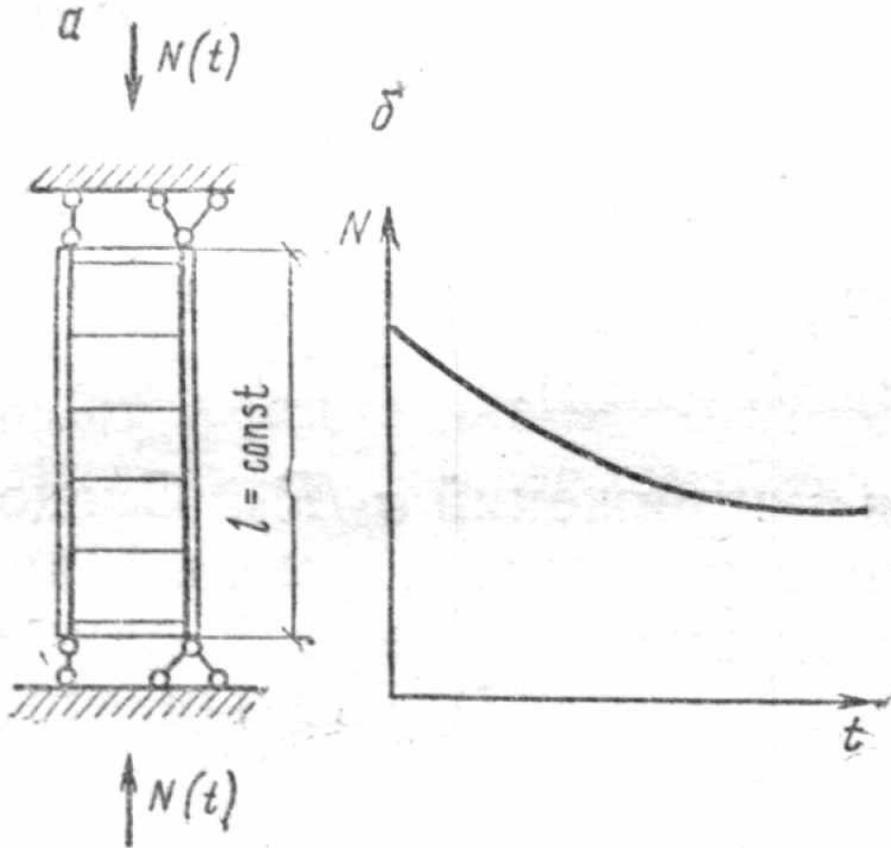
Релаксация напряжений в бетоне при постоянных напряжениях в арматуре железобетонной призмы
